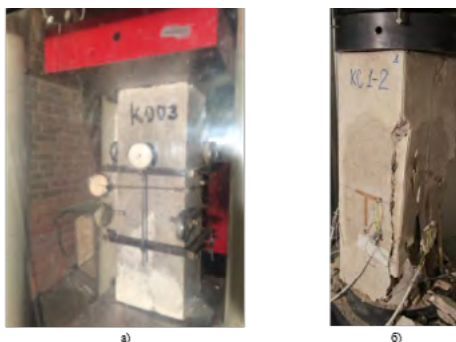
Образец бетонной конструкции, армированной стеклокомпозитной арматурой: а) до испытания, б) после испытания
